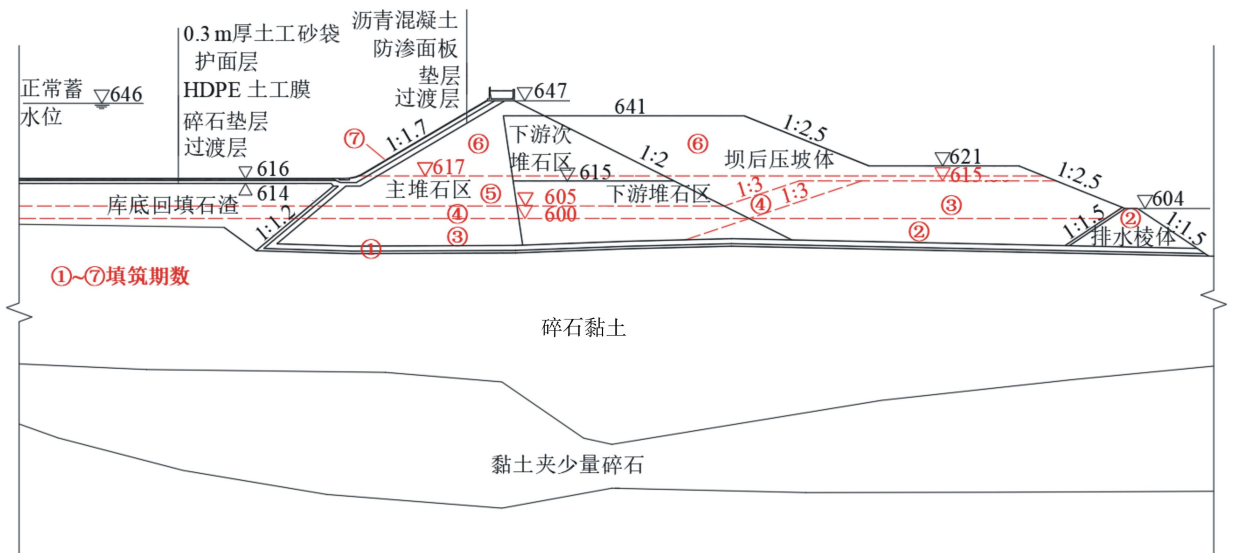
上水库大坝典型剖面及分期施工示意图(单位:m)
